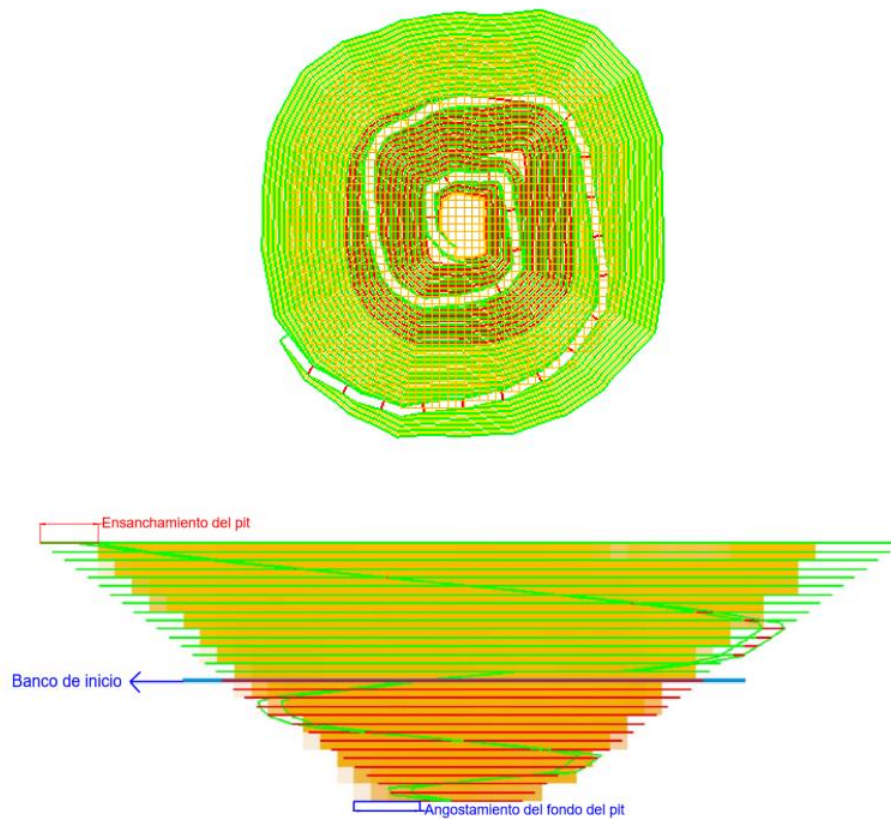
Diseño de rampa mixto, vista planta y lateral (Cerón, 2019).
